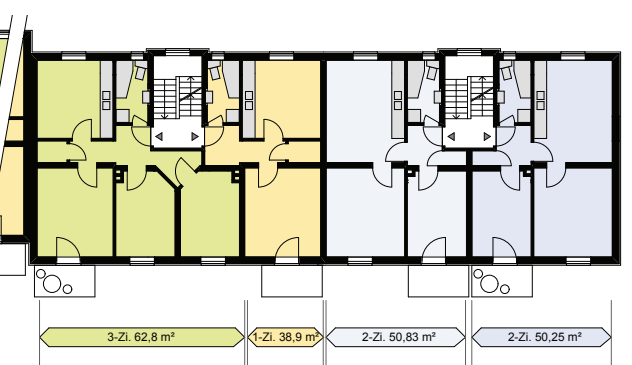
Grundrisse 1./2. OG Weiden, Marienbader Straße 1–9
